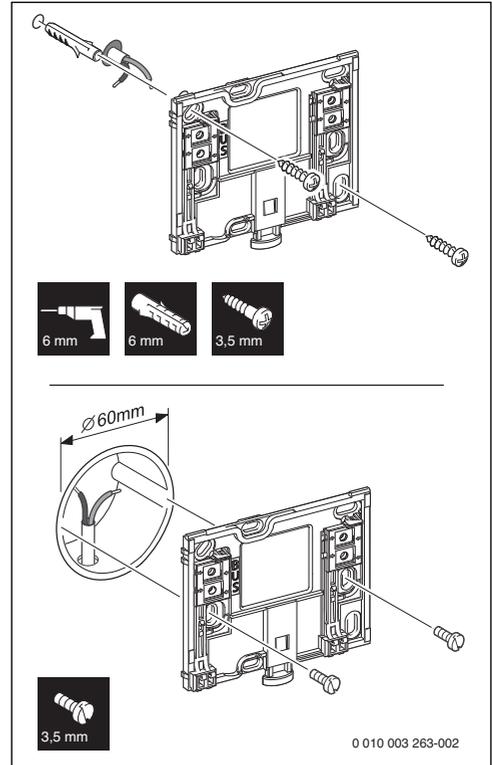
Montaggio della basetta di supporto per installazione a parete
